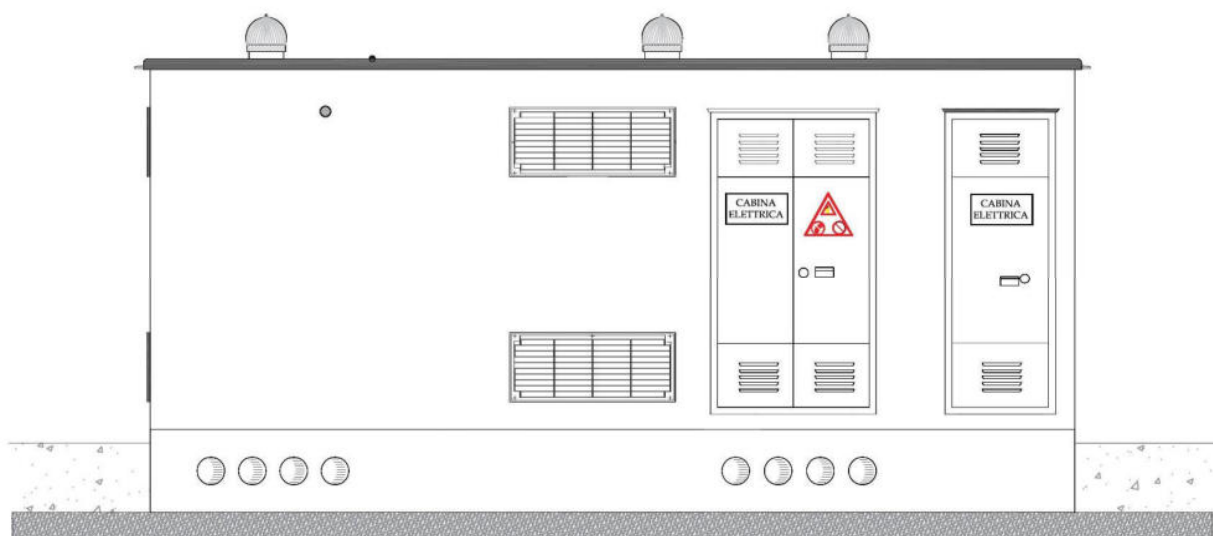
Cabina Mt - prospetto anteriore (lato strada)
